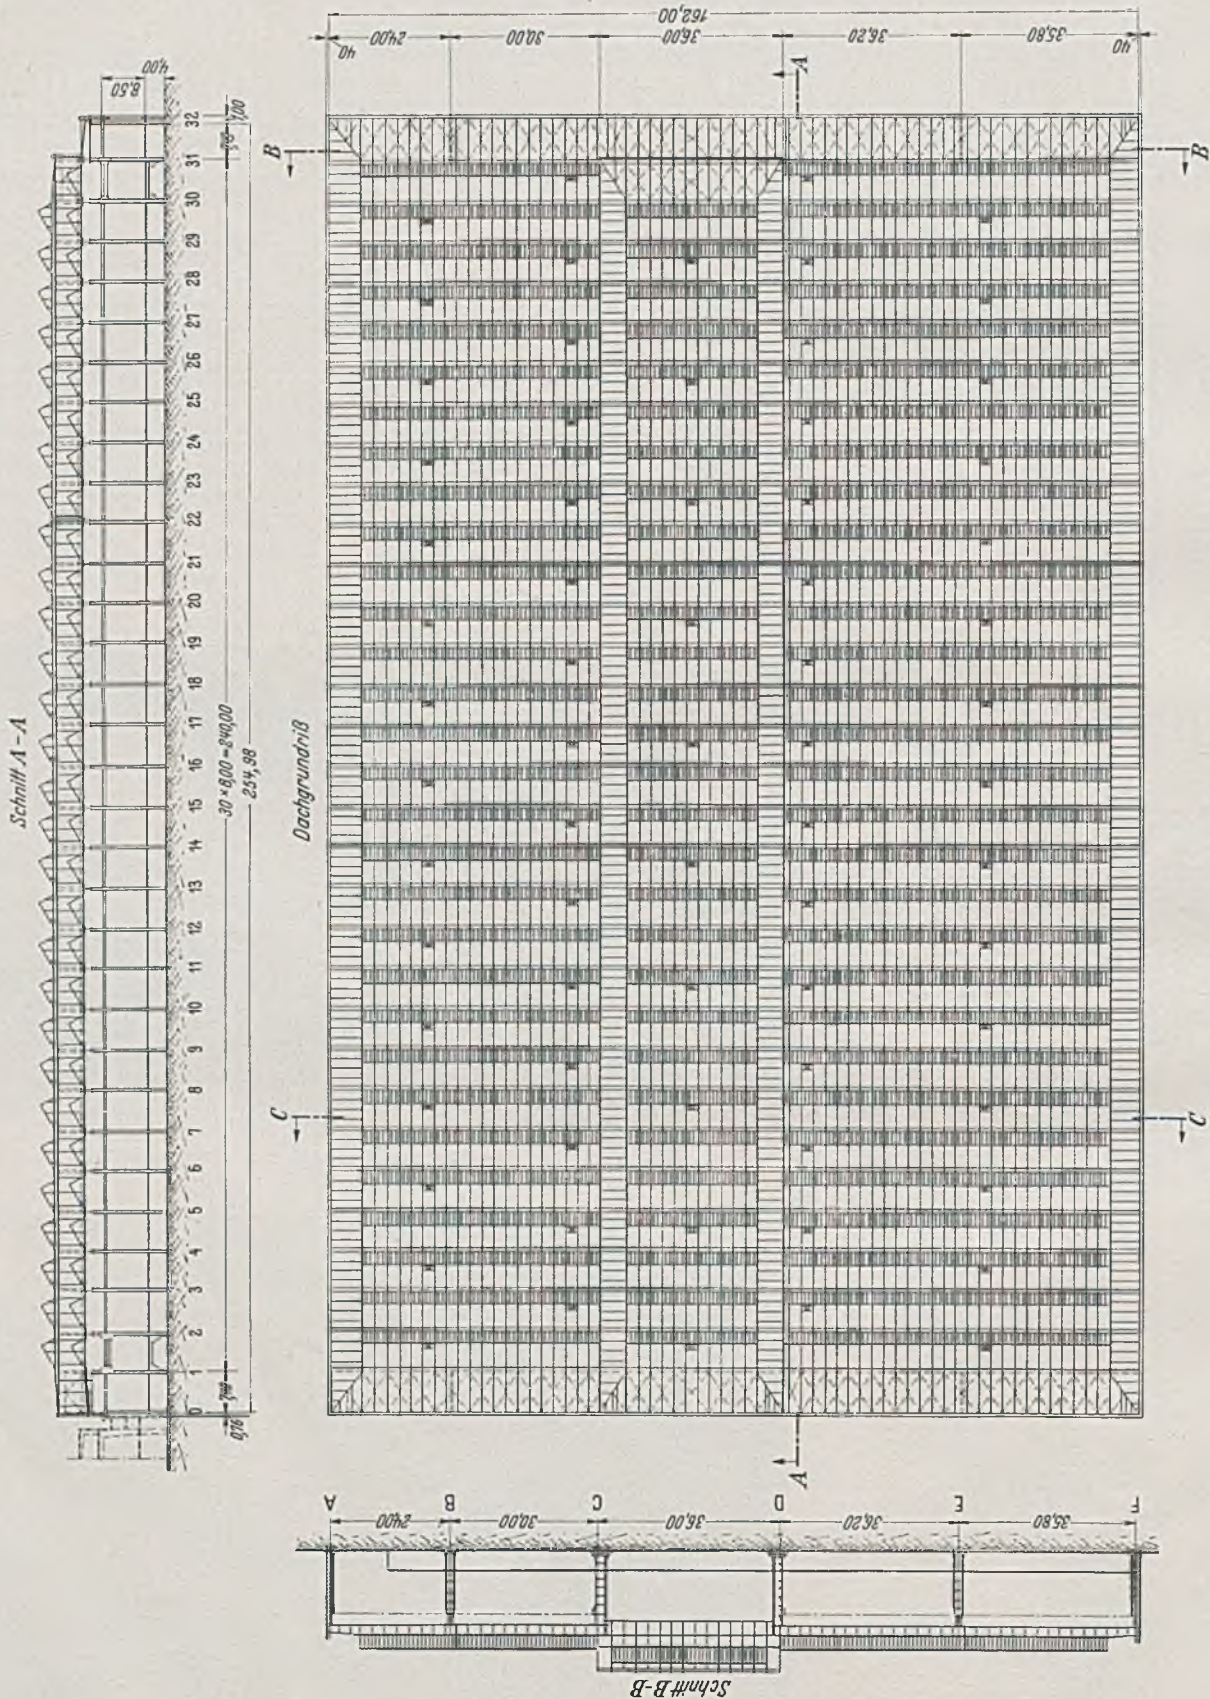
Bau 10: „Preßwerk“, Grundriß, Quer- und Längenschnitt.
